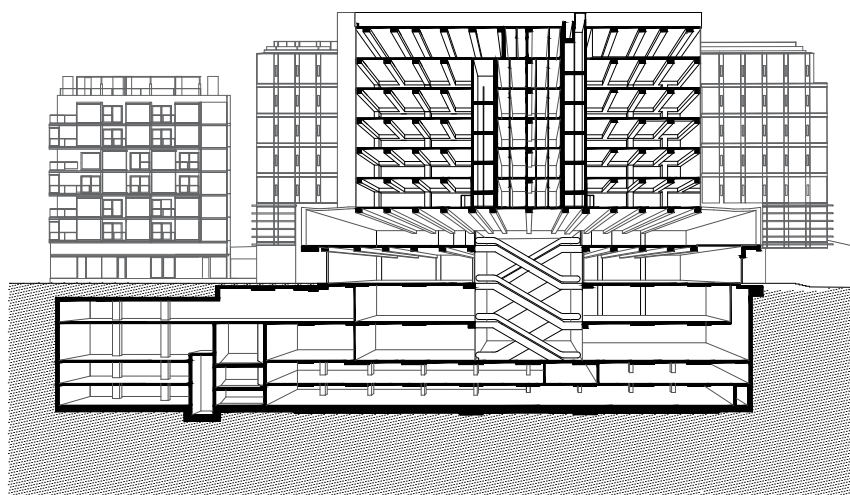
Perspektivní řez Domem uměleckého průmyslu 1:1000.
